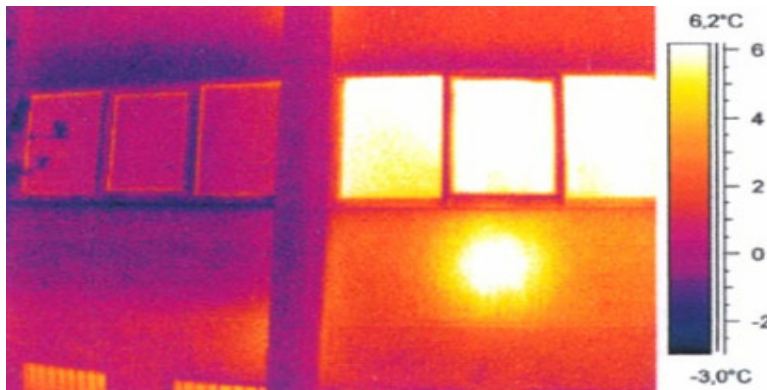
Yapılarda Isı Köprüleri Kolon-Kiriş-Taban-Tavan Bağlantı Bölgelerinde Oluşur
